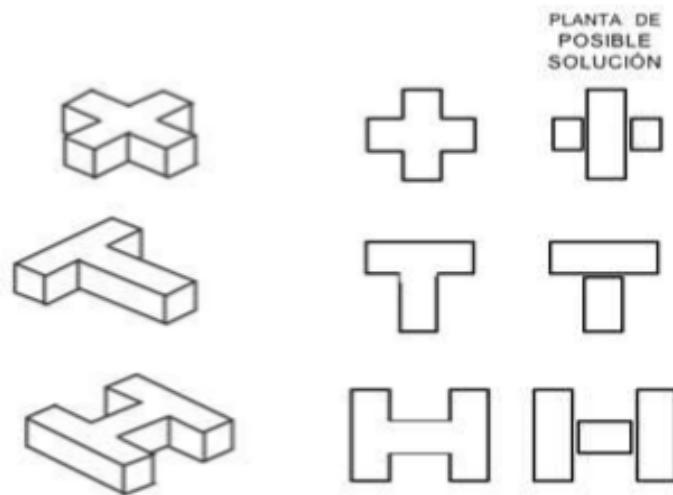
Ejemplos de plantas de forma irregular y su posible solución.
